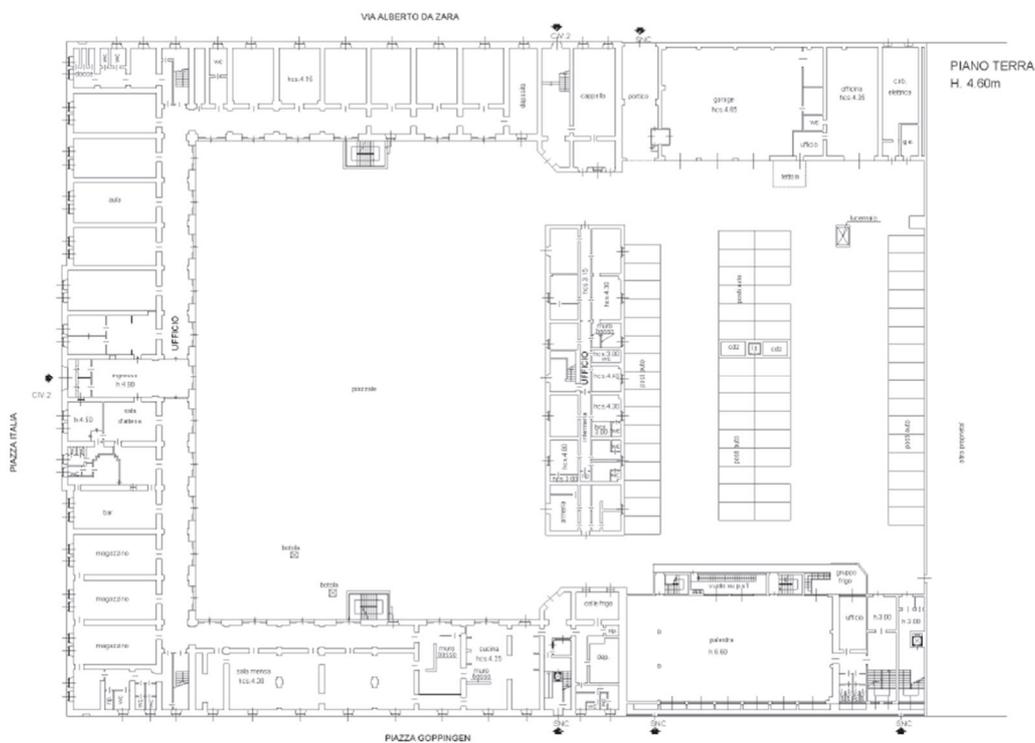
Planimetria della distribuzione architettonica del Piano Terra
